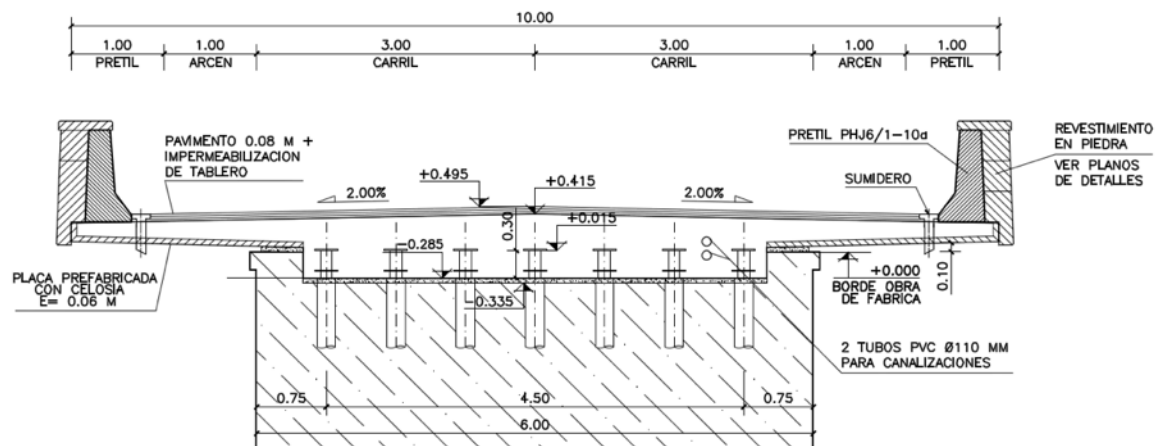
Sección transversal, losa armada con micropilotes en pilas y voladizos con prelasas. [18]
